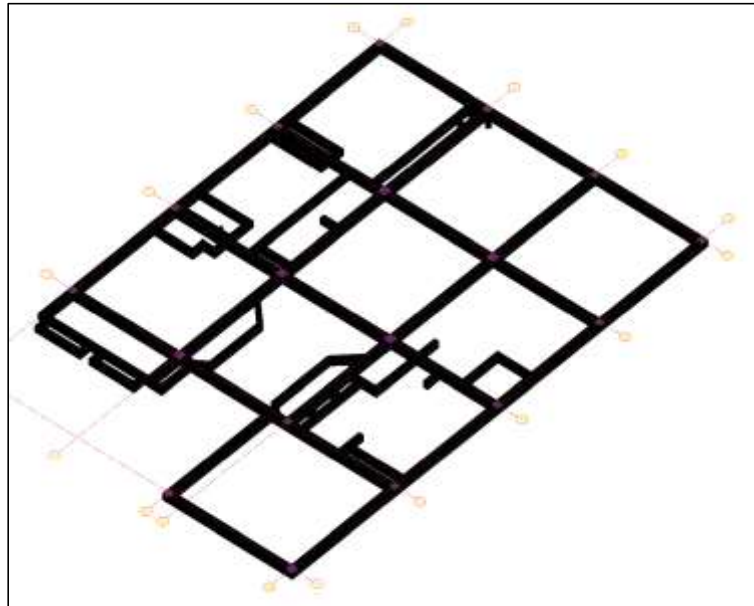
Secuencia de procesos constructivos en la construcción de una vivienda.2. Elementos estructurales en concreto (Superestructura).
